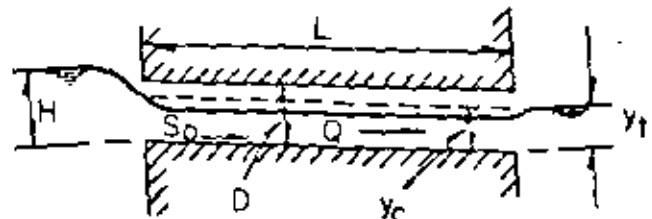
TIPOS DE FLUJO EN ALCANTARILLAS
